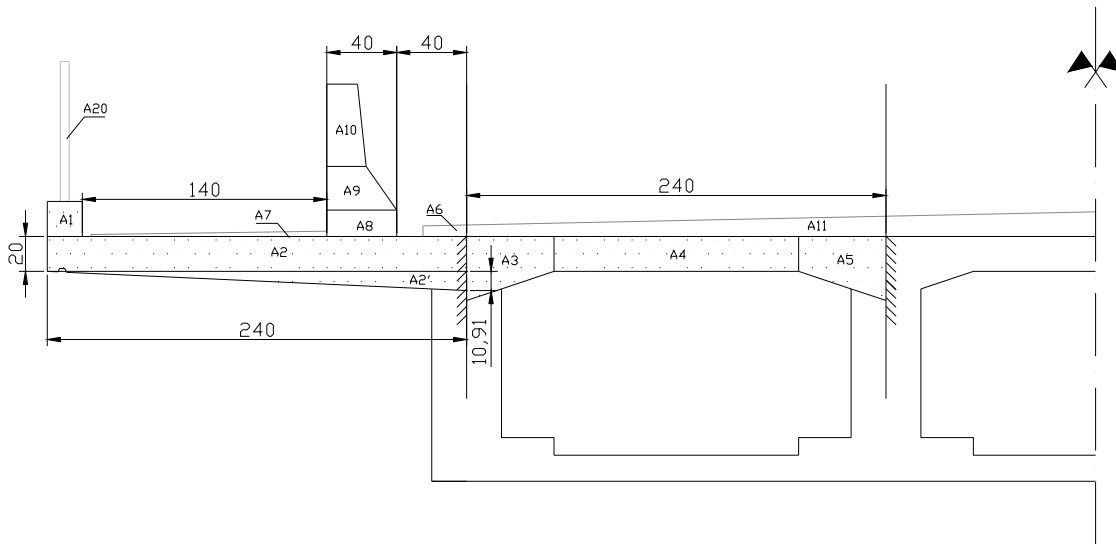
Esquema para o cálculo das lajes em balanço e centrais
